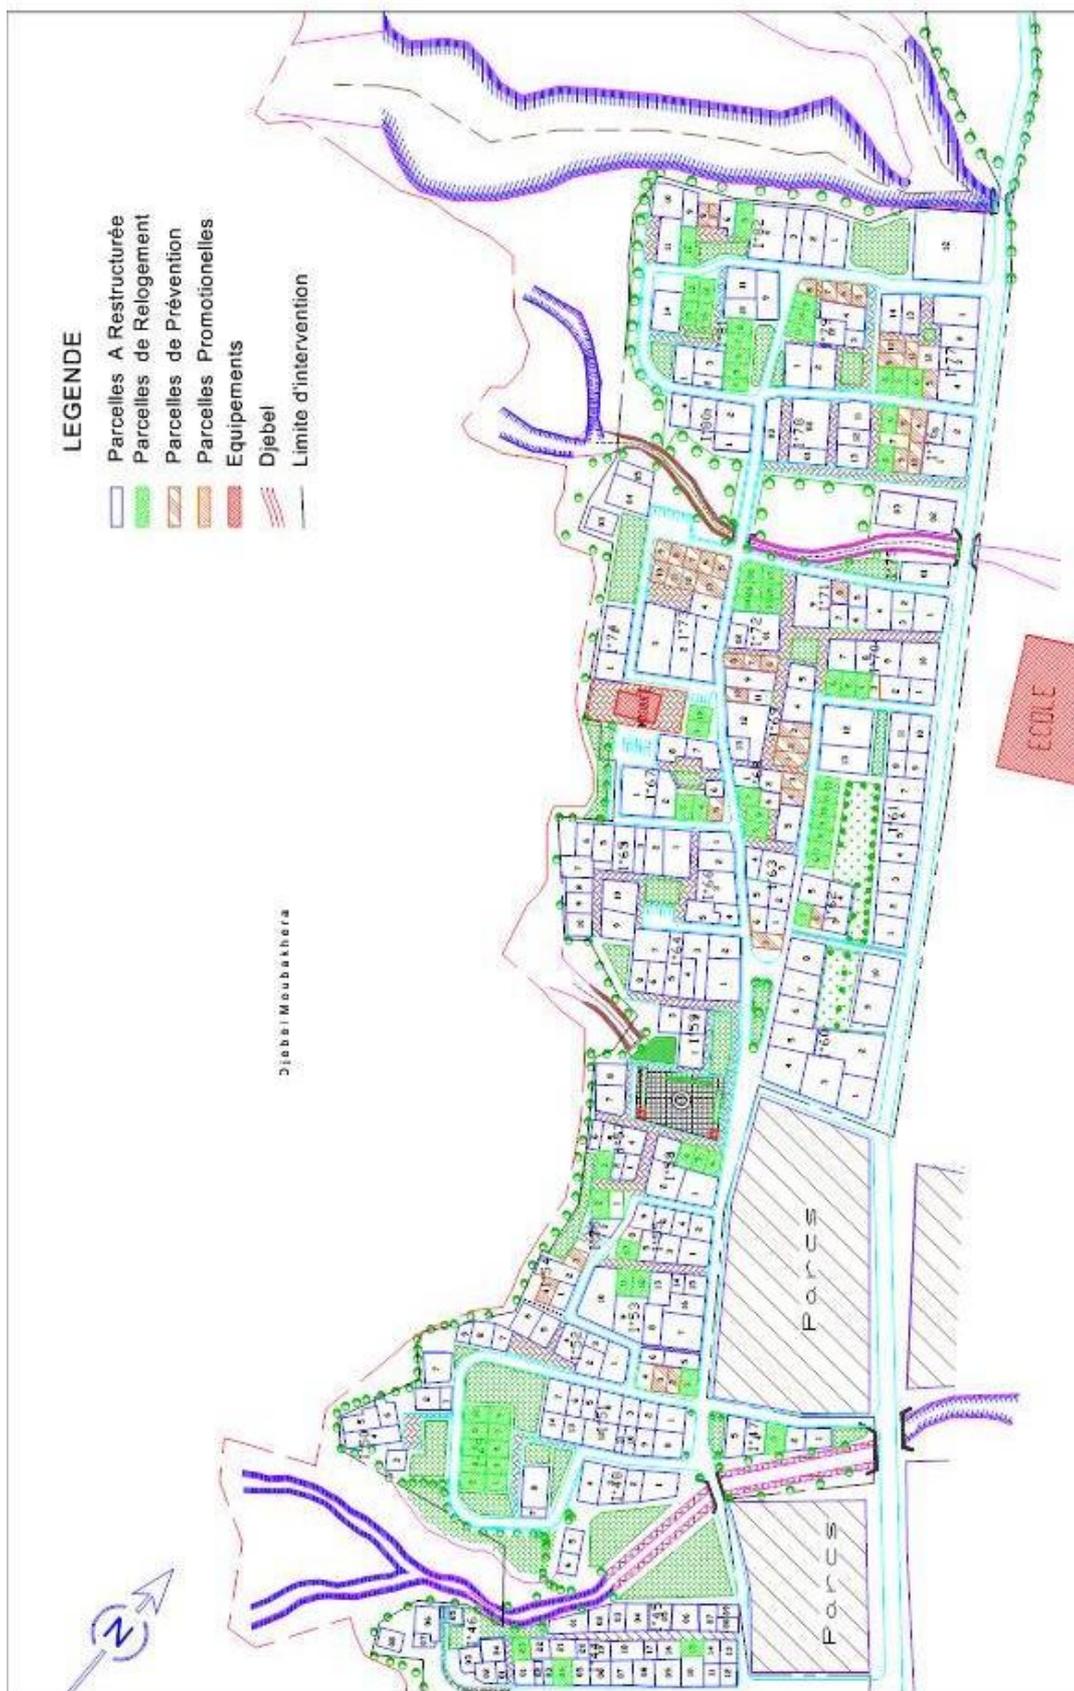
Plan d'aménagement R.H.P Maïtar (partie 03 Khrabcha)
